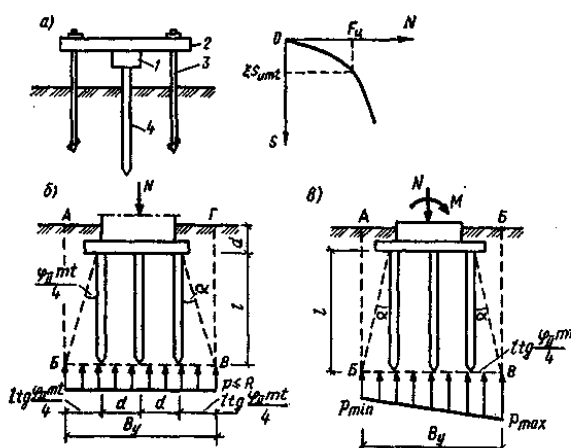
Схема испытаний сваи статической нагрузкой и расчетные схемы свайных фундаментов: а – схема испытаний и график зависимости осадки сваи от нагрузки; б – схема к расчету свайных фундаментов при центральной нагрузке; в – схема для внецентренного действия нагрузок;
